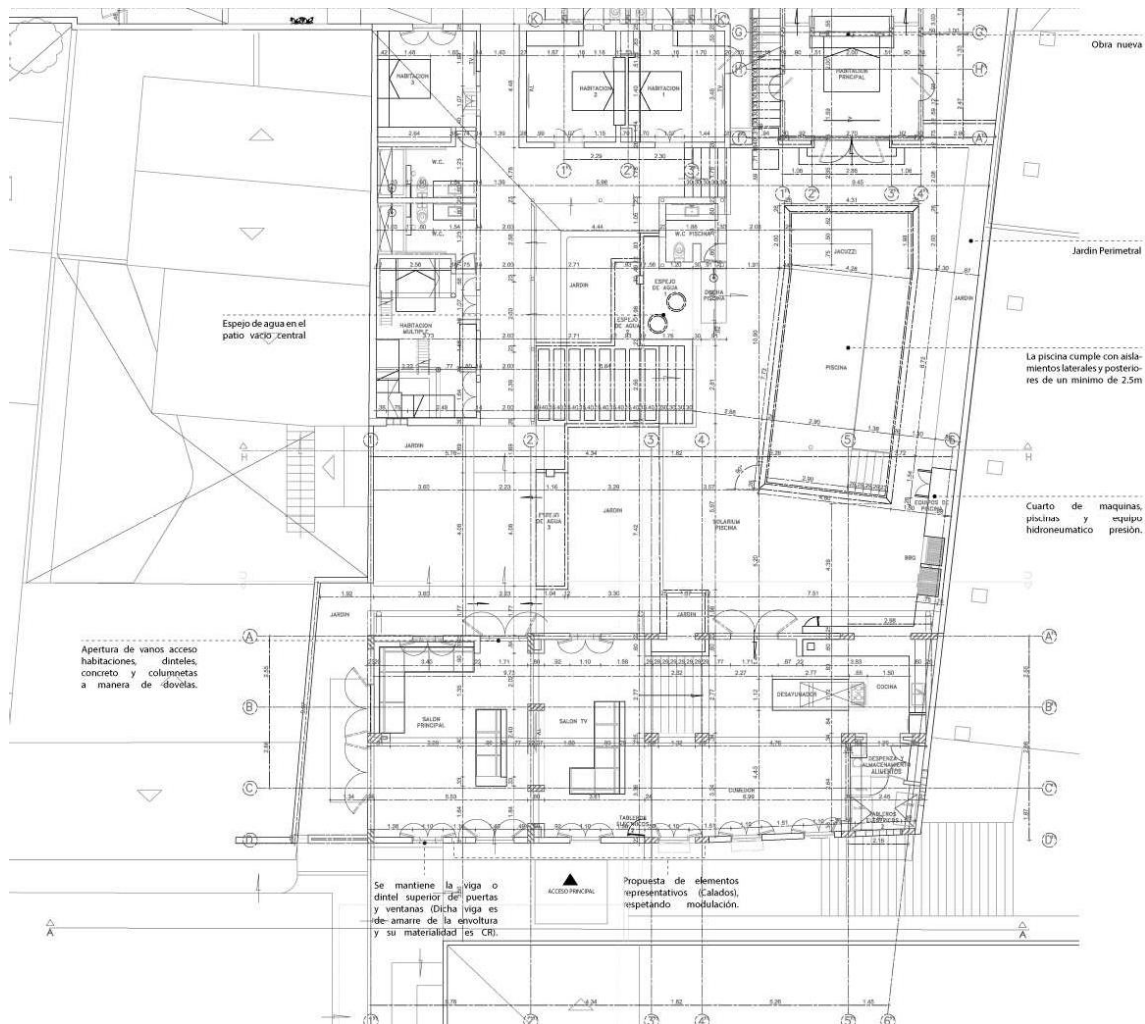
(Planta arquitectónica principal, fuente propia,2018)
